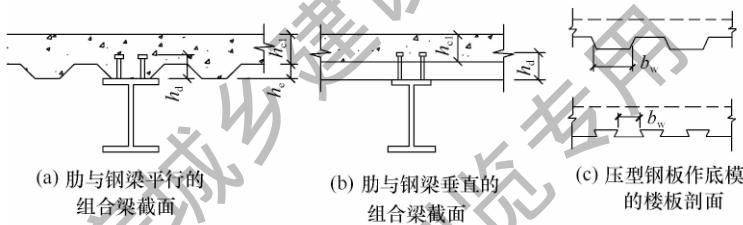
用压型钢板作混凝土翼板底模的组合梁
